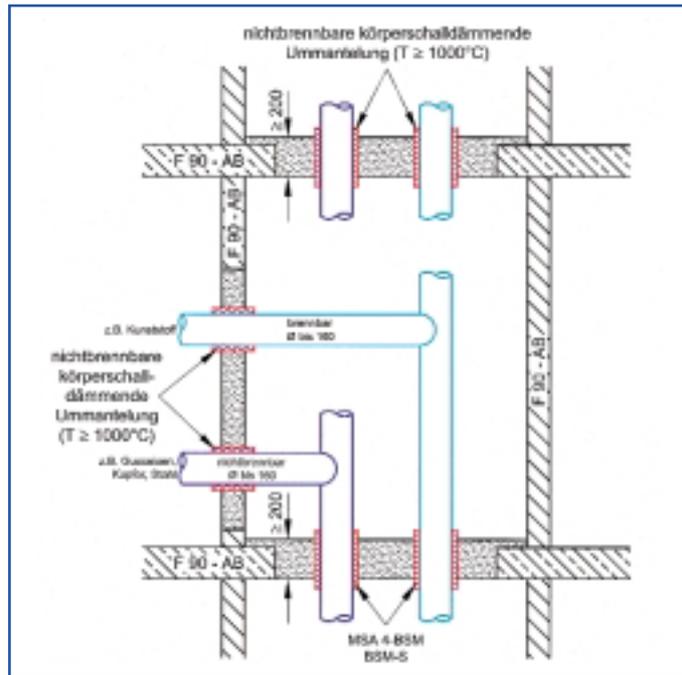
Mischinstallation von Sanitär- und Heizungsleitungen im F90-Installationsschacht nach DIN 4102 Teil 4
